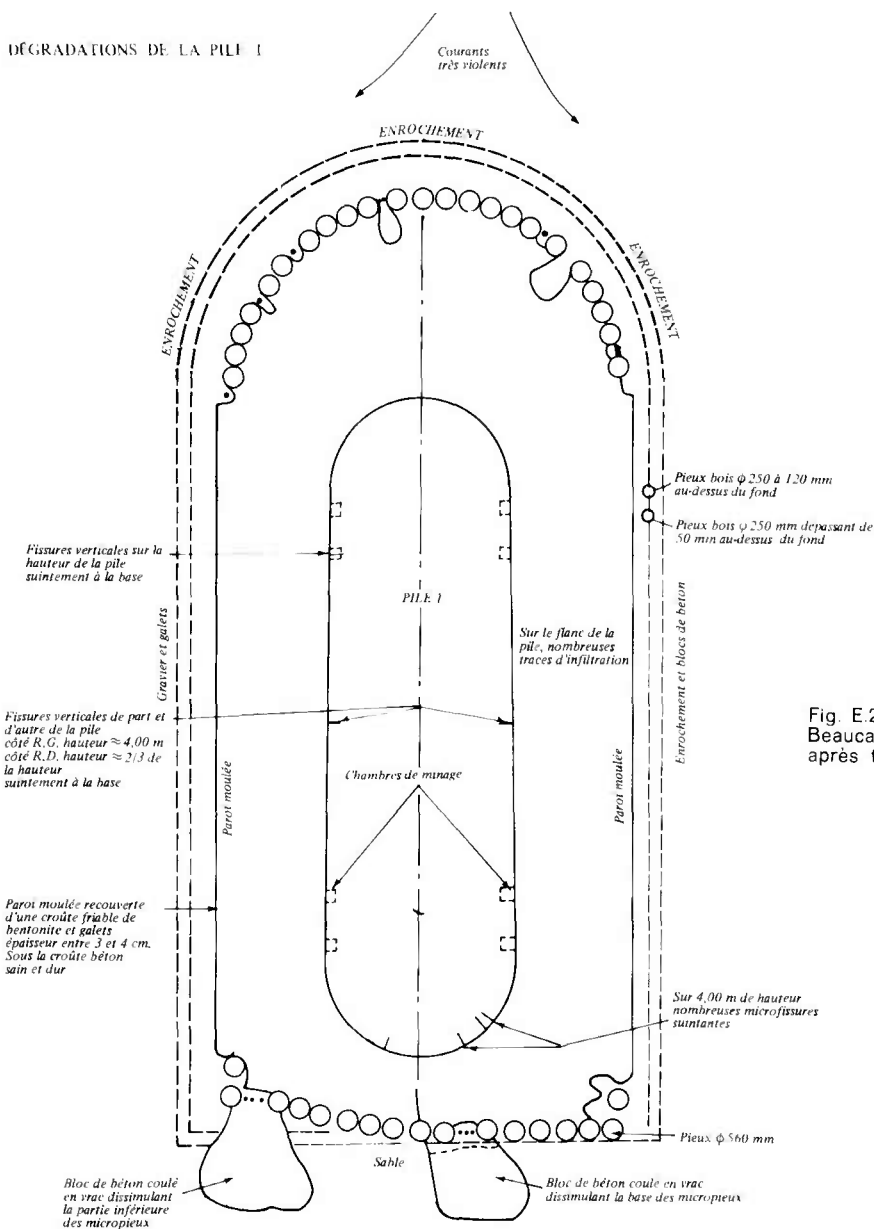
Pont de Beaucaire - Désordres observés après travaux.
